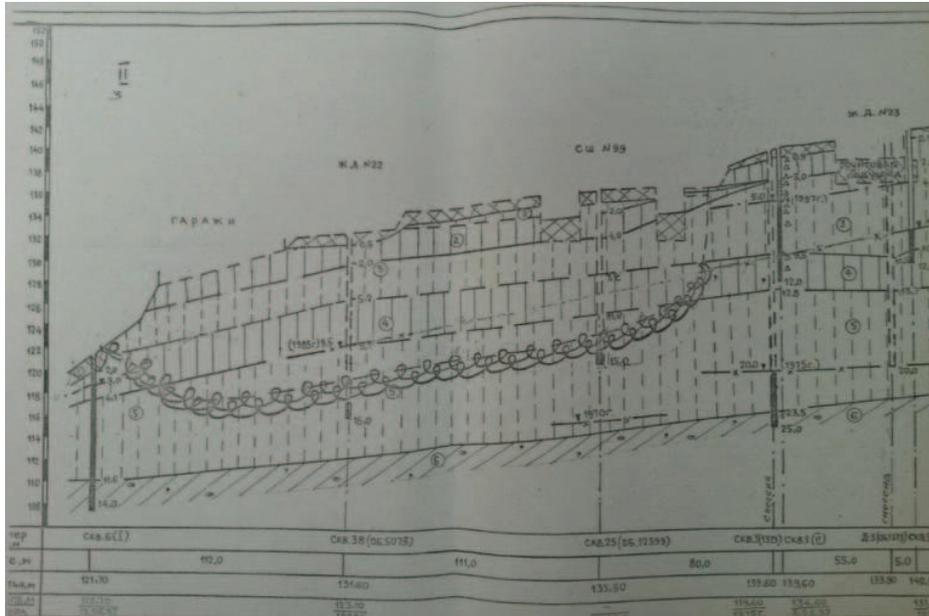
Геологический разрез склона балки Встречной, разрушенного оползнем в 1997 году, г. Днепропетровск
